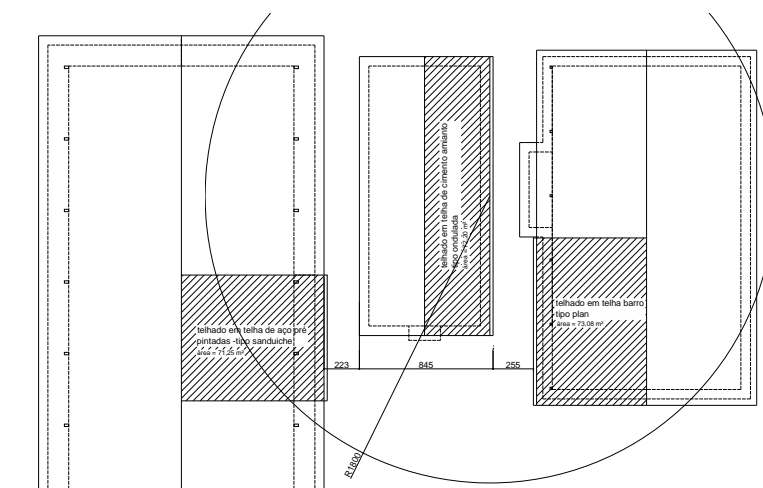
Planta de cobertura das edificações de onde serão captadas as águas de chuva
